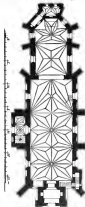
Grundriss der Kirche zu Bonn.
